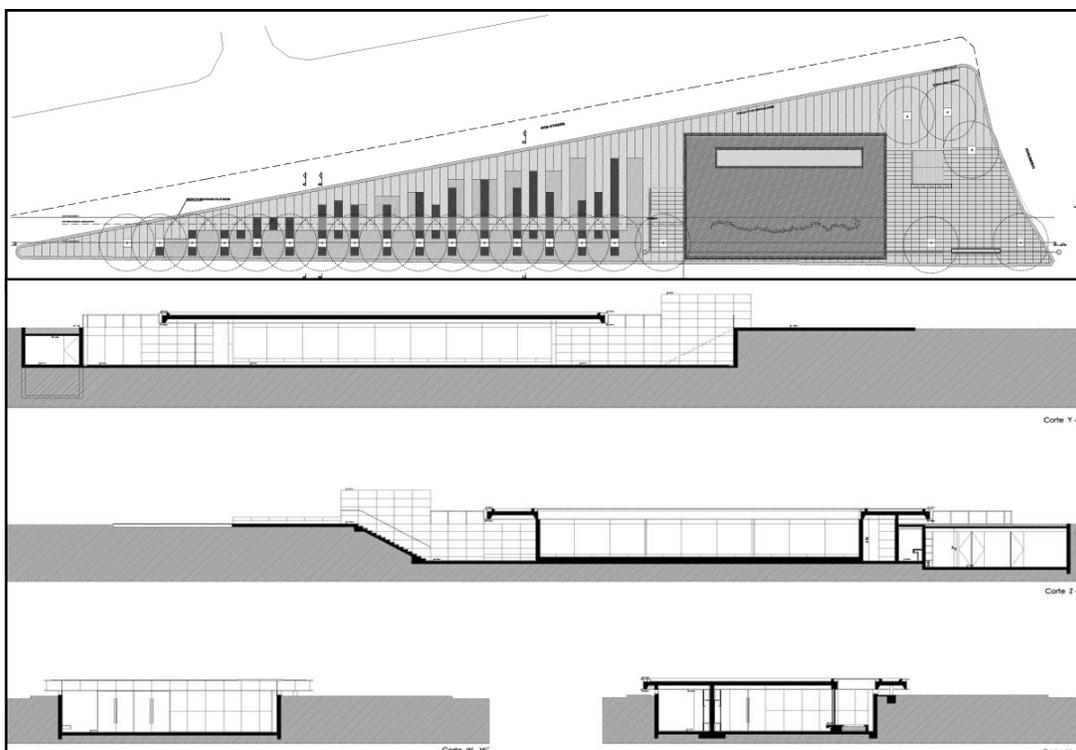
e 19: Planta baixa do projeto. Cortes demonstrando os níveis e os detalhes do projeto.
